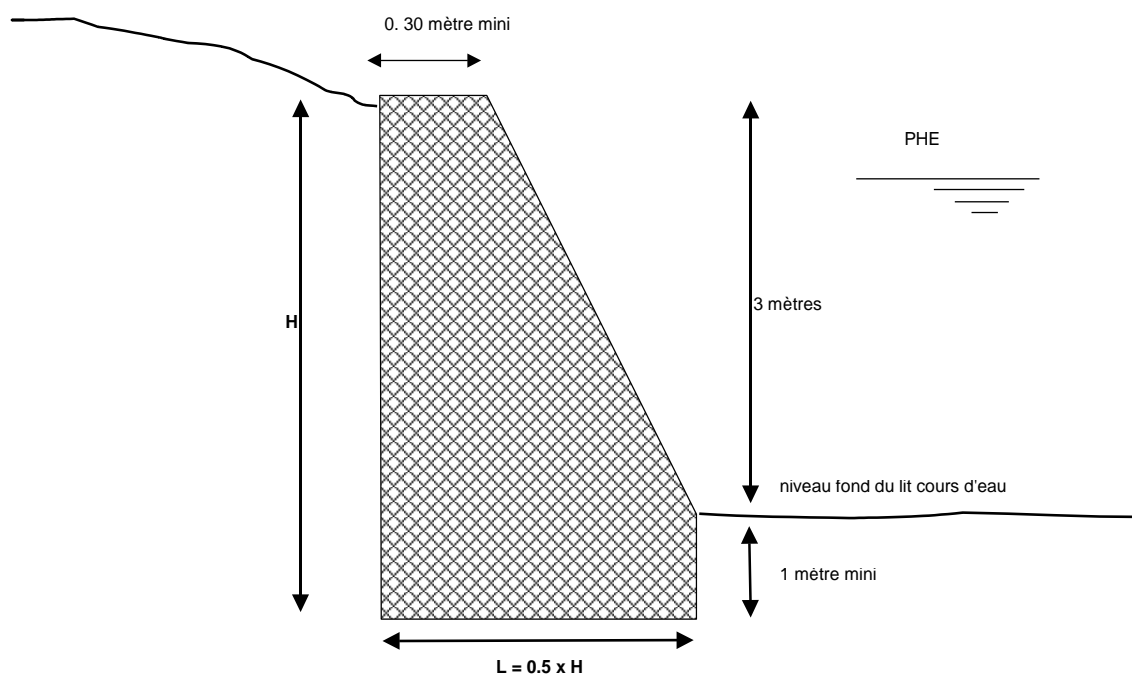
Schéma d'un mur de soutènement en maçonnerie au droit d'un cours d'eau
